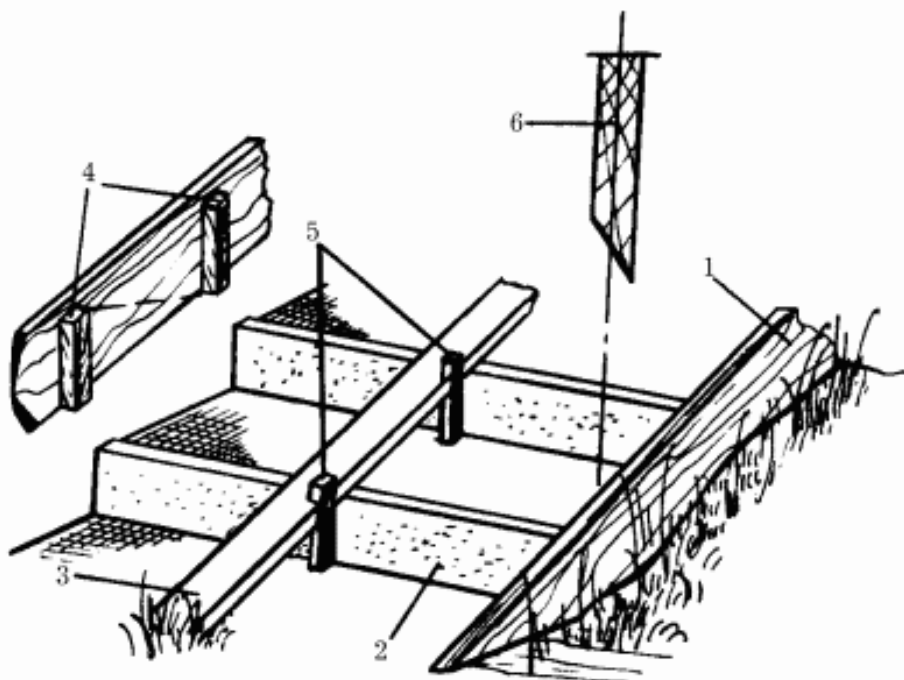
Конструкция опалубки для прямой лестницы: 1 – доска косоура (тетива); 2 – доска подступени; 3 – срединная доска; 4 – бруски; 5 – колышки; 6 – профиль доски подступени с кромкой, срезанной «на ус».
